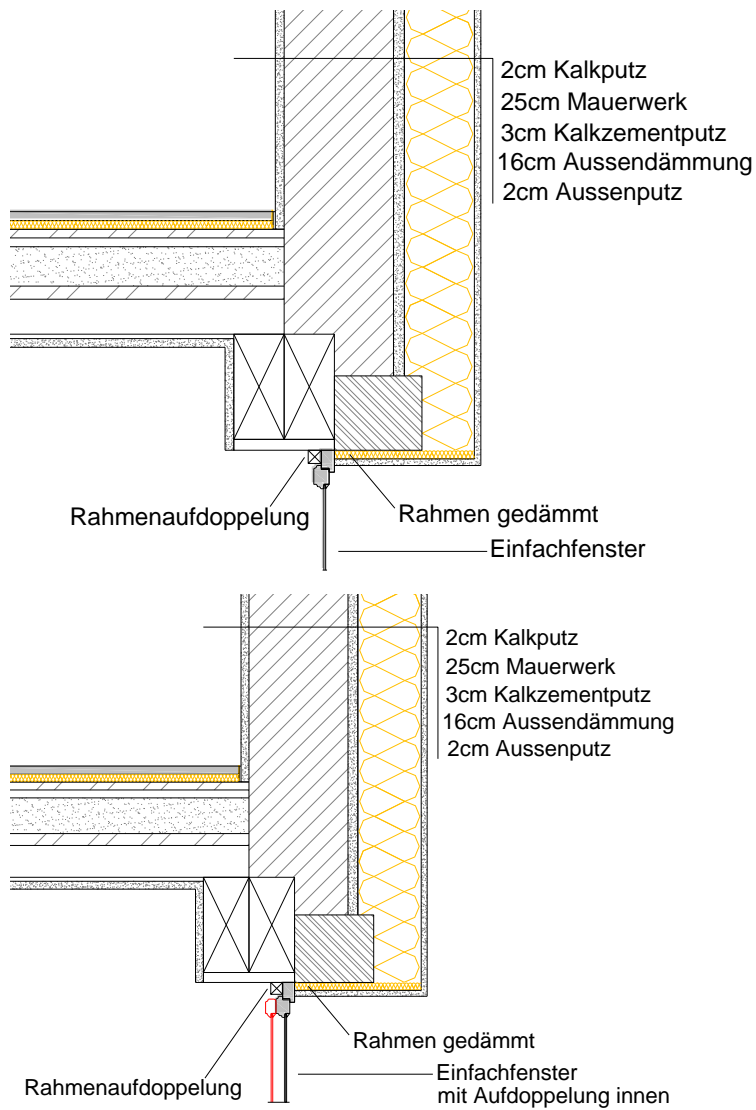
Fensteranschlussdetail Sturz bei Einfachfenster (oben) und Einfachfenster mit Aufdoppelung innen (unten) mit Aussenwärmedämmung, Leibungsdämmung und Rahmenaufdoppelung
